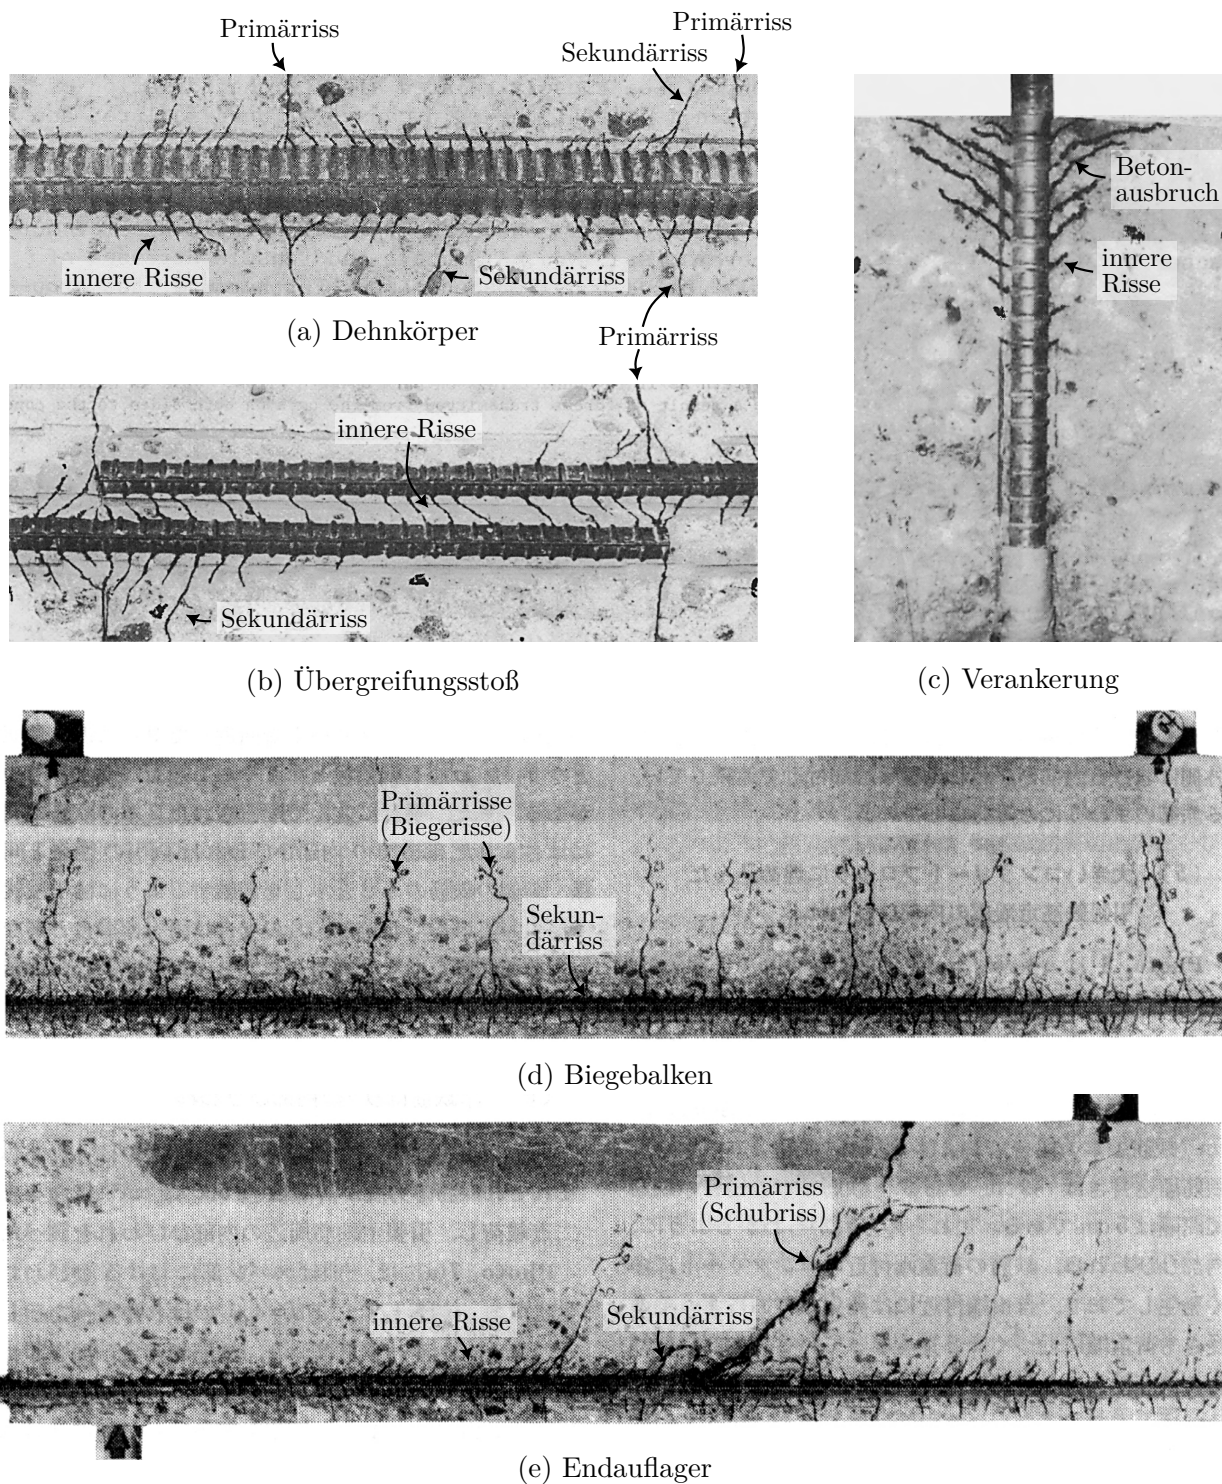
Eingefärbte Verbundrisse im Längsschnitt (a) eines Dehnkörperversuchs, (b) eines Übergreifungsstoßversuchs, (c) eines verankerten Bewehrungsstabes, (d) der Feldmitte eines Biegebalkens und (e) des Endauflagerbereichs eines Biegebalkens; entnommen und modifiziert aus [Goto u. Otsuka 1979]
